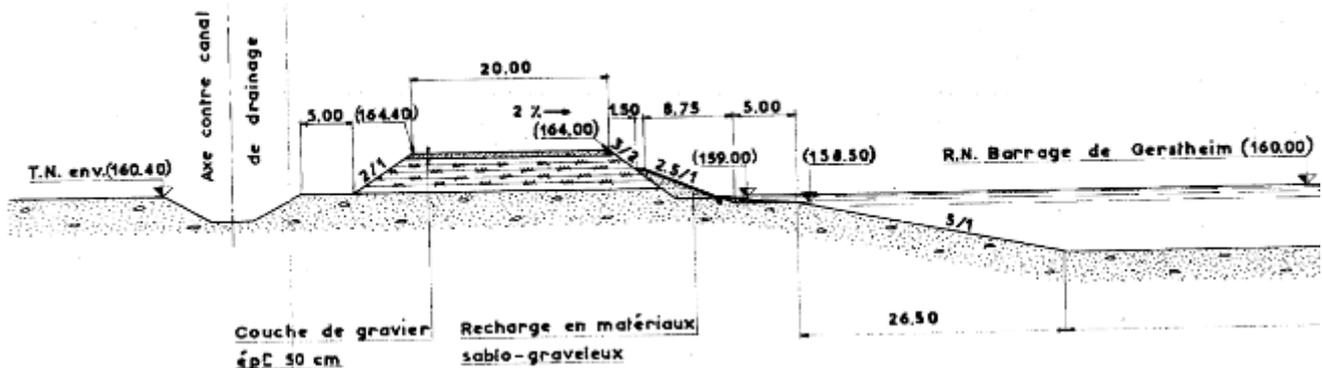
Exemple de profil en travers d'une digue de canal de restitution sur un aménagement du Rhin Nord (bief de Rhinau)
